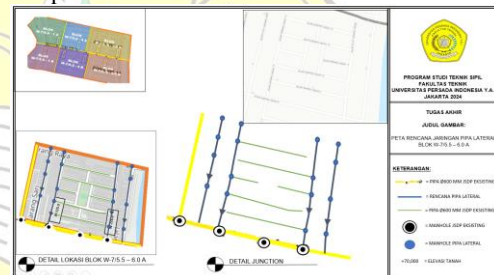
Peta Rencana Sub-Pelayanan Jaringan Pipa Lateral Air Limbah Blok W-7/5.0 - 1 A
